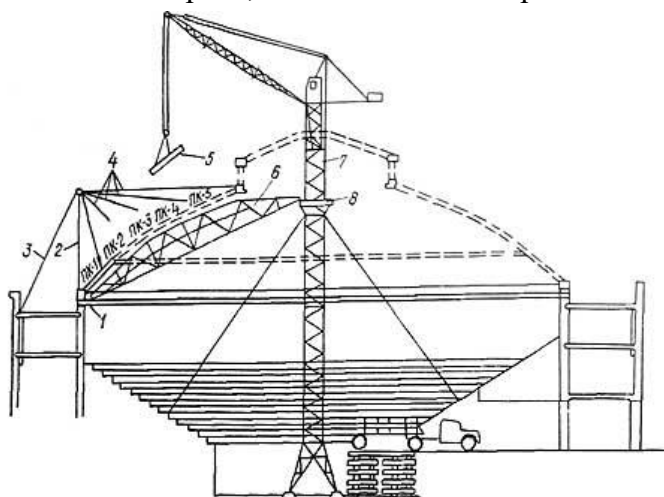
Схема монтажа купольного покрытия: 1 — кольцевой рельсовый путь; 2 — стойка-мачта; 3 — тросовые расчалки; 4 — стержневые подвески; 5 — панели купола; 6 — ферма-шаблон; 7 — башенный кран; 8 — опорная площадка
